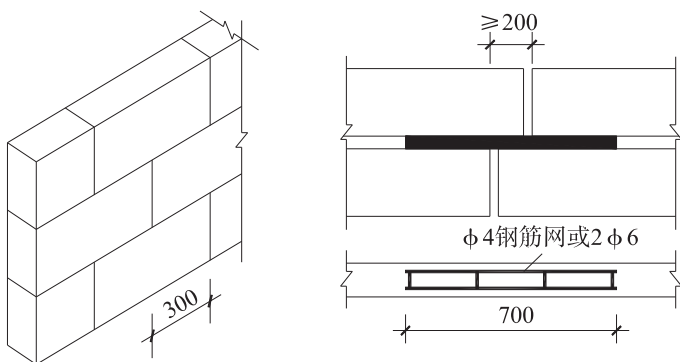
蒸压加气混凝土砌块砌筑形式
